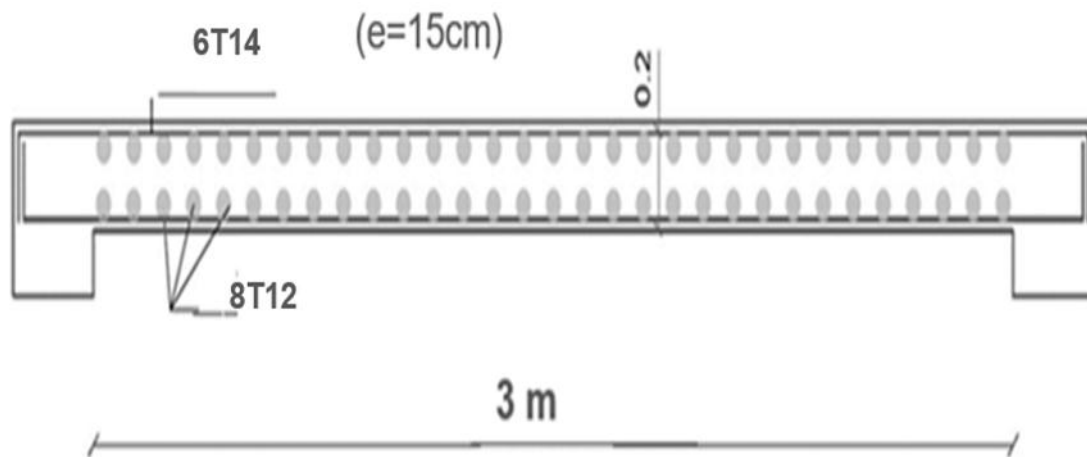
Schéma de ferrailage de voile de contreventement.
